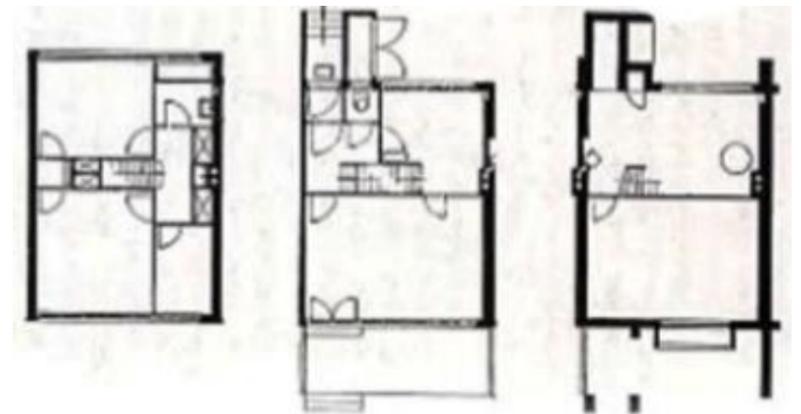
Plantas arquitectónicas base, referentes a la construcción de la vivienda plurifamiliar.
